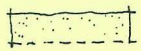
ZULÄSSIGE DACHAUFBAUTEN
